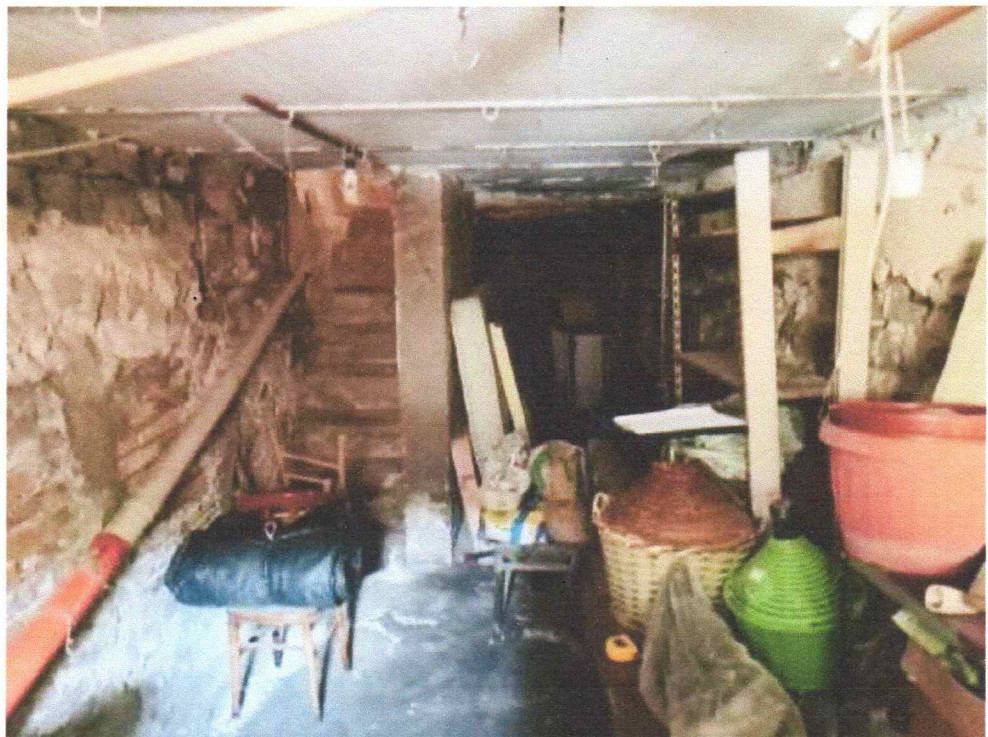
di 6 – Vista interna (Piano seminterrato)
